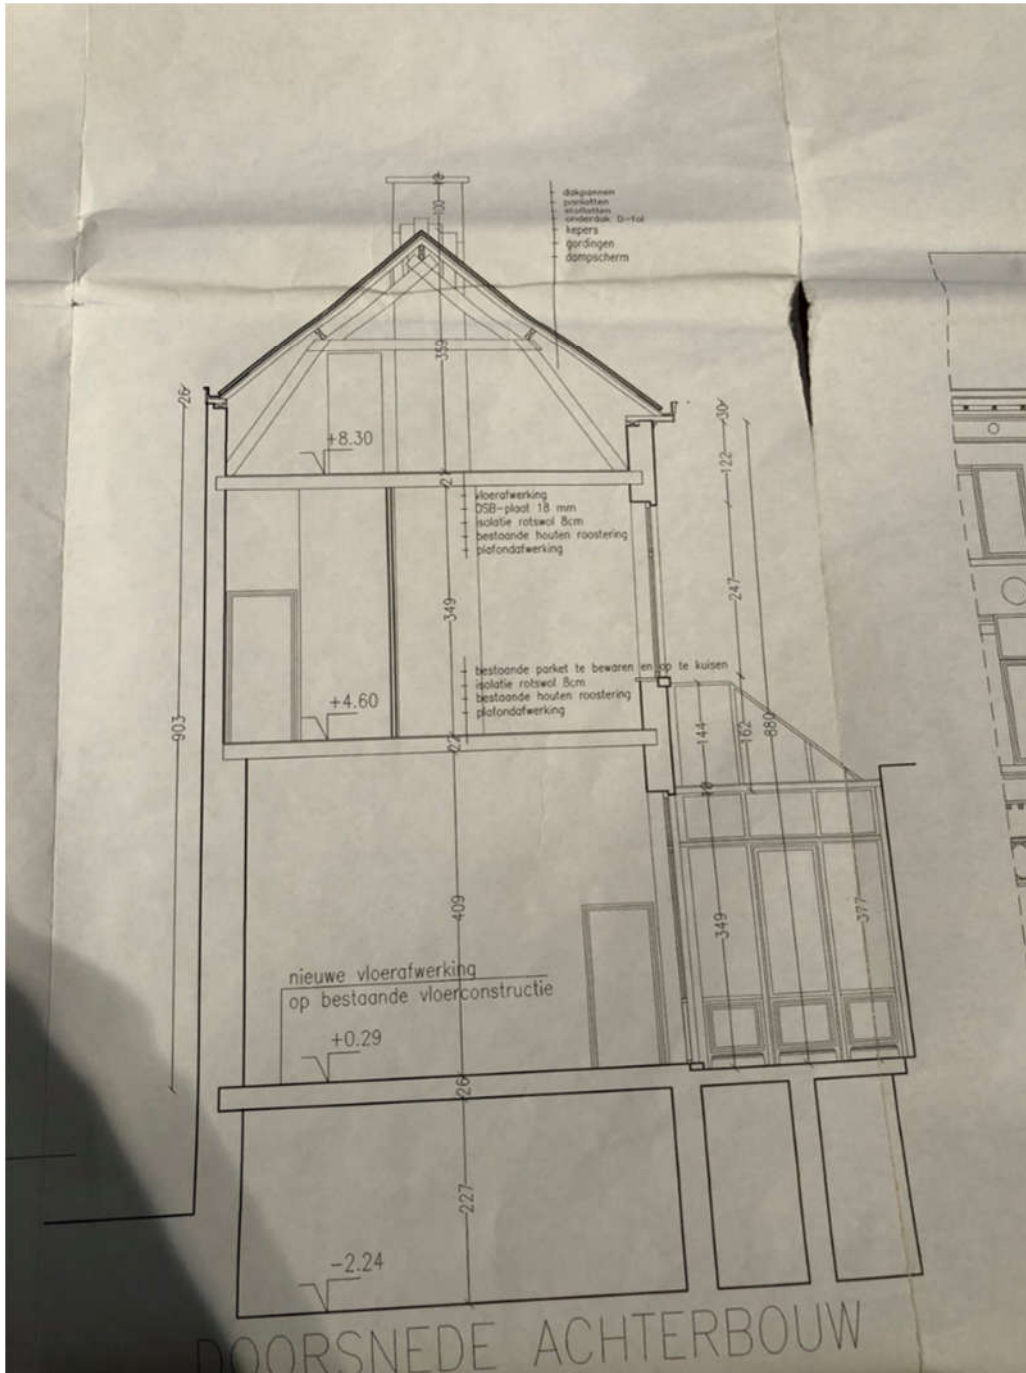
Doorsnede, plan door arch. J. Van Dorpe
